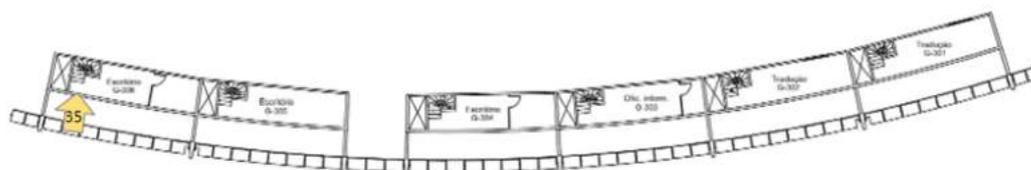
Planta do mezanino do CB II – Montagem Autor: Silva, A. 2020
